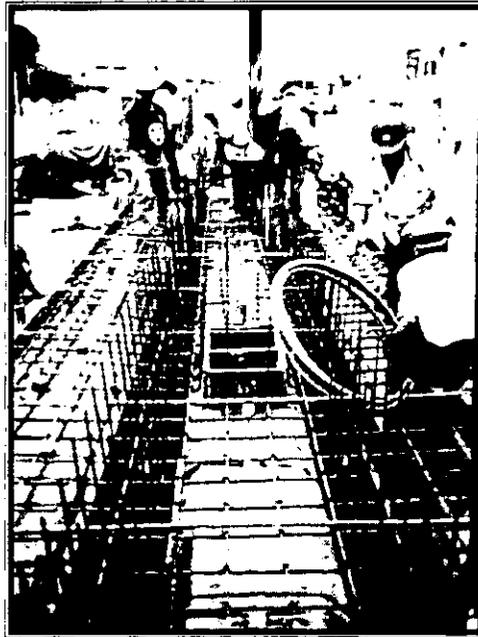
Construcción de los aligerantes para las traves de presfuerzo.
